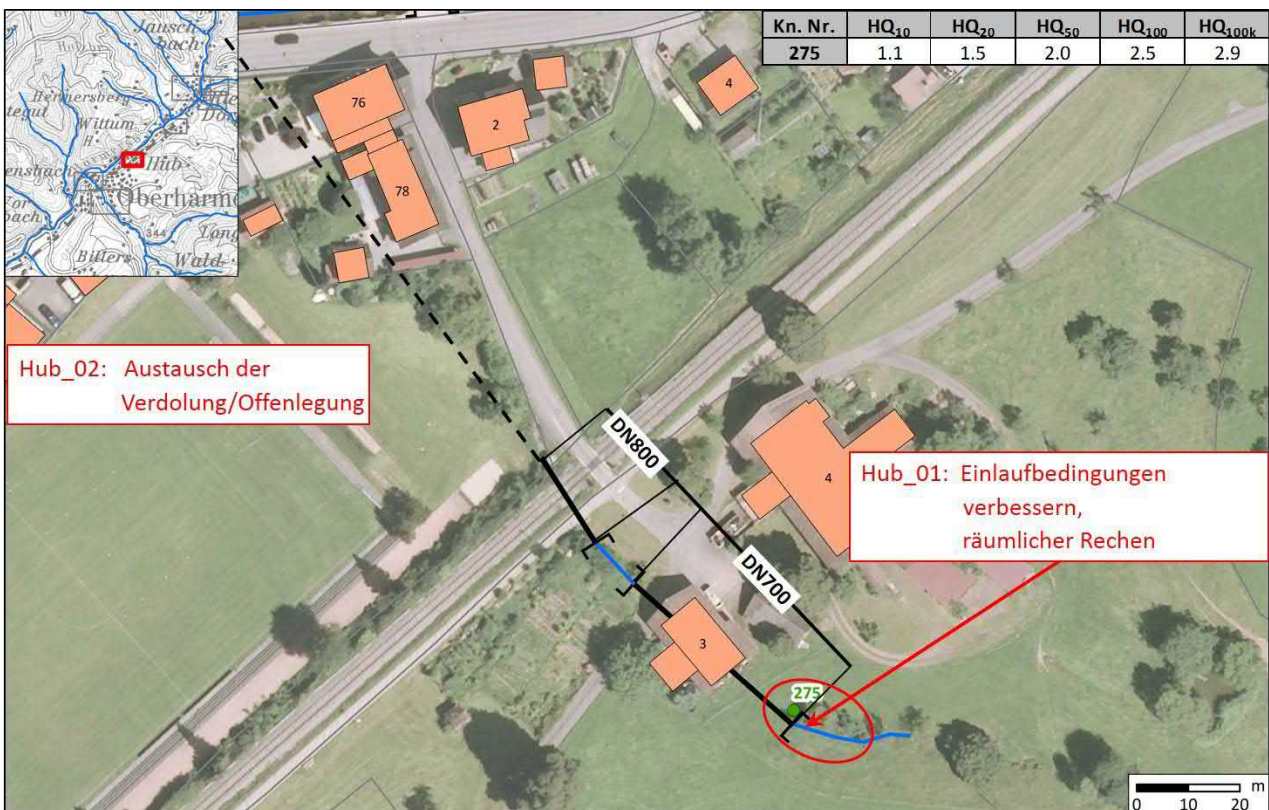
Außenbereich Hubbächlein – Lageplan mit vorgeschlagenen Maßnahme
